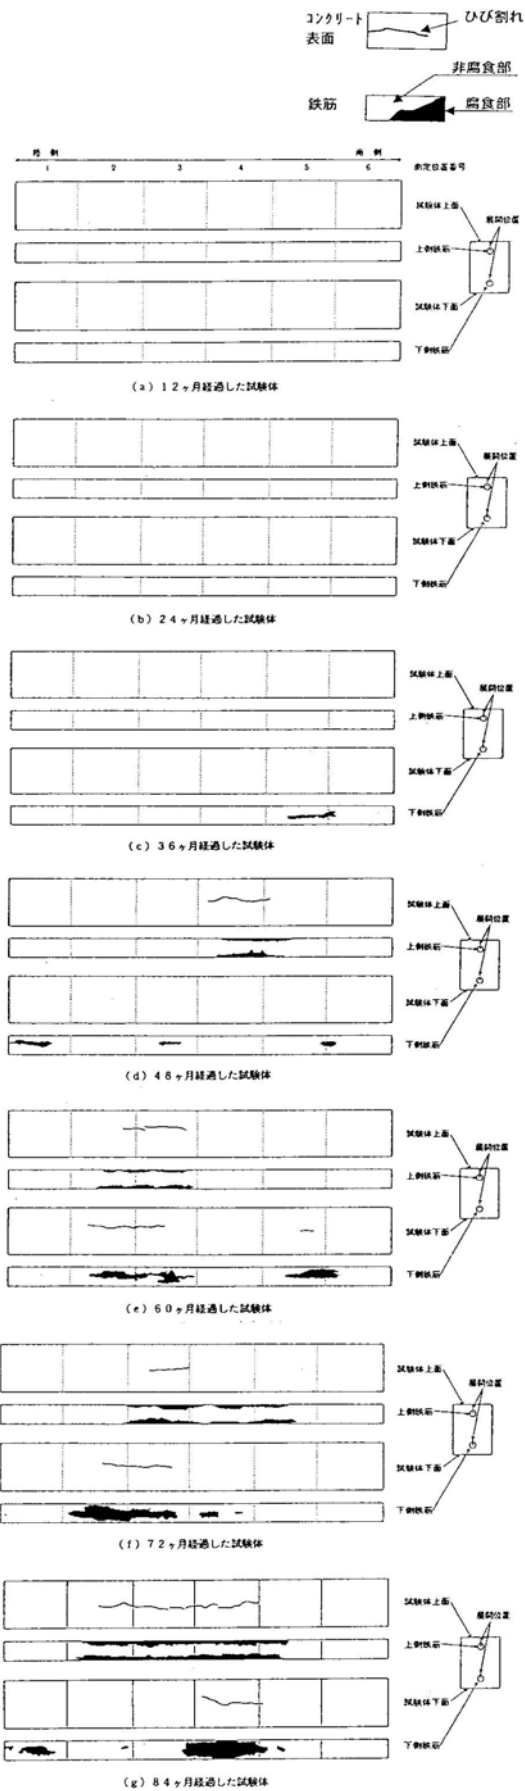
沖縄共通試験体のひび割れと腐食状況
